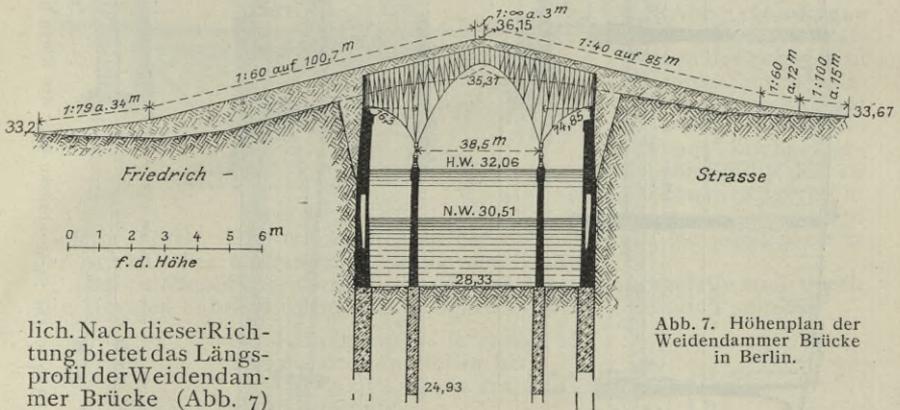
Höhenplan der Weidendammer Brücke in Berlin.
